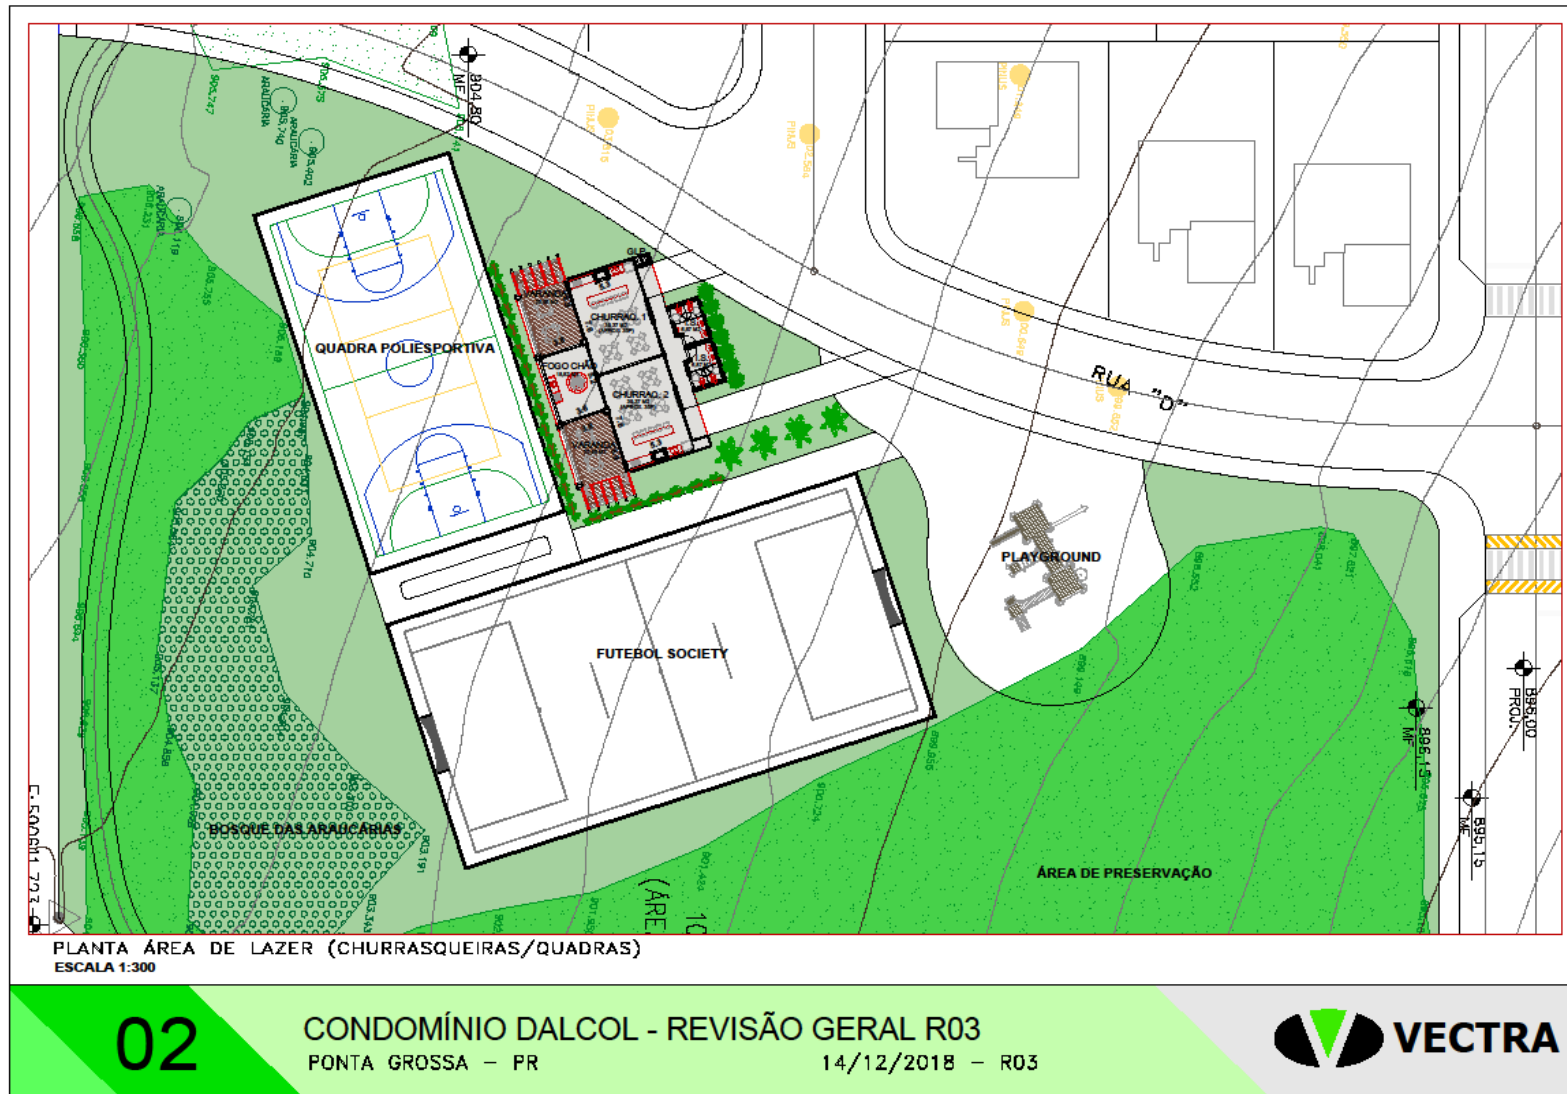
Planta área de lazer (churrasqueiras / quadras).
